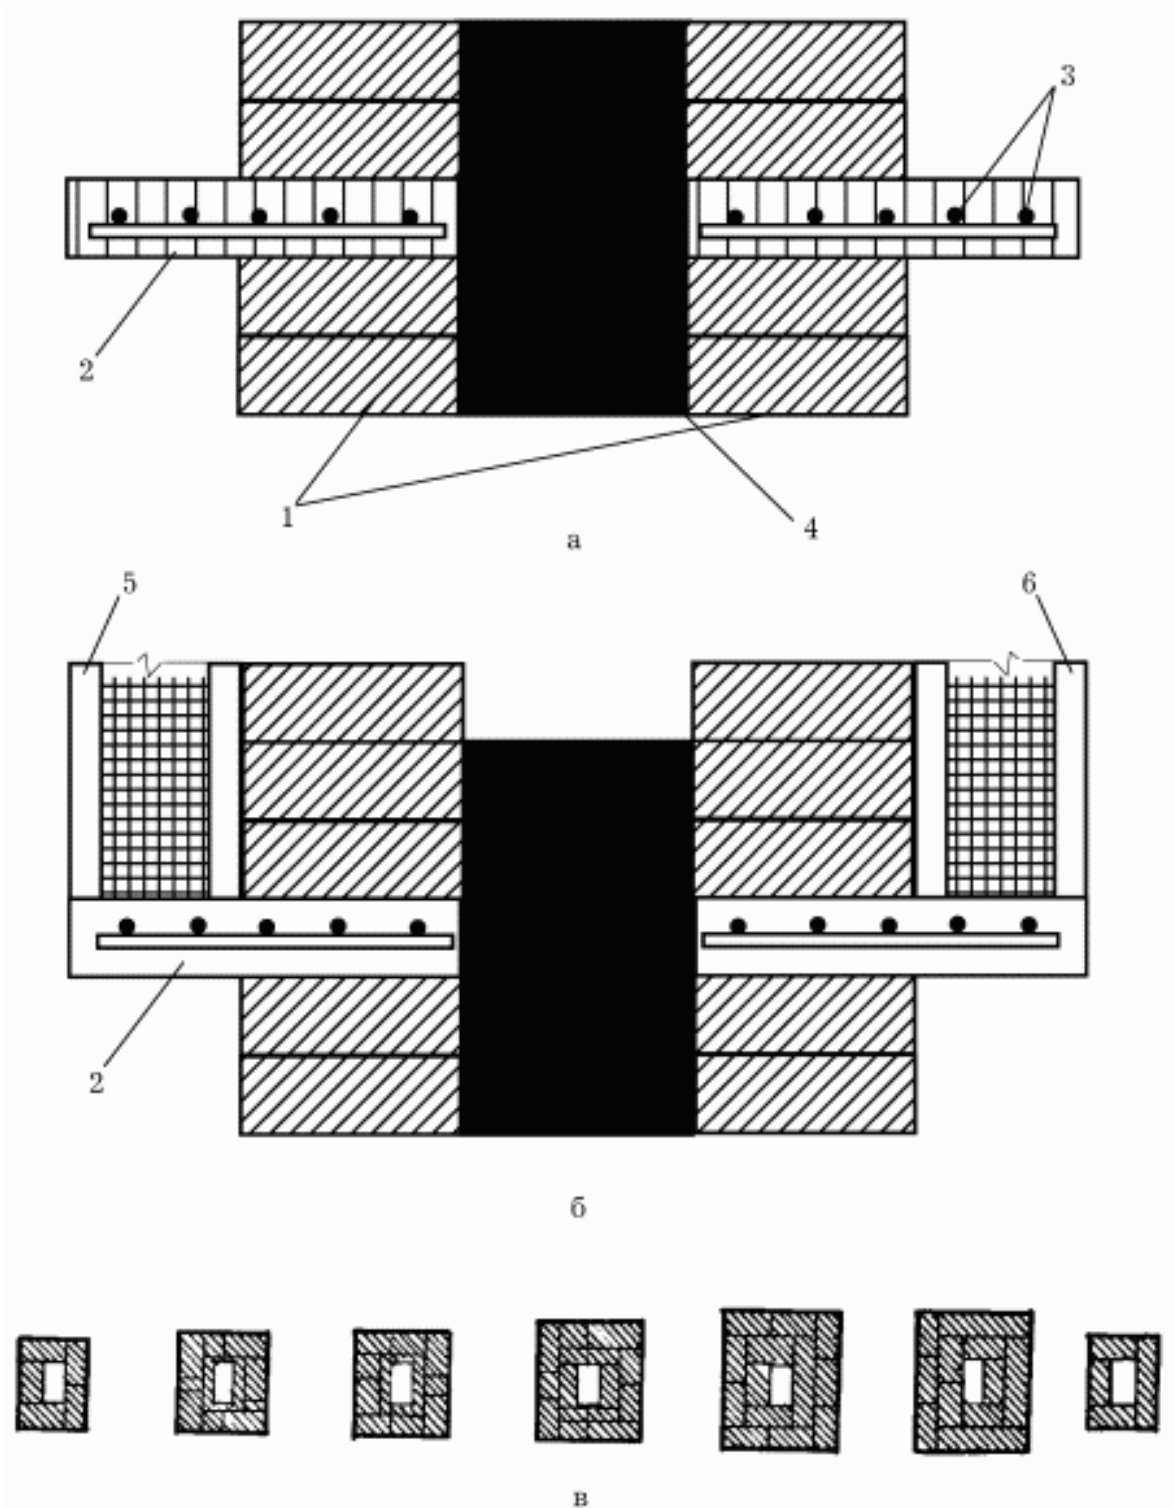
Устройство распушки: а – железобетонная распушка; б – распушка в виде ящика с песком; в – последовательность кладки распушки: 1 – печная кладка; 2 – бетон; 3 – арматура; 4 – дымоход; 5 – стенки ящика; 6 – песок.
